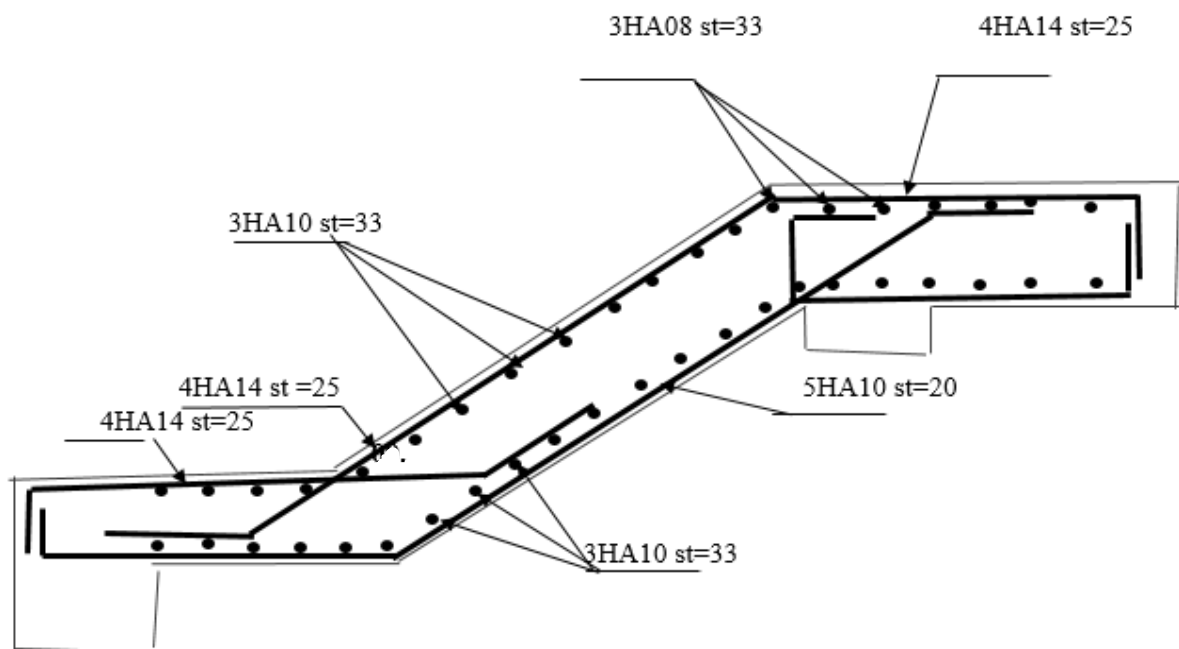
Schéma de ferrailage d'escaliers type 02
